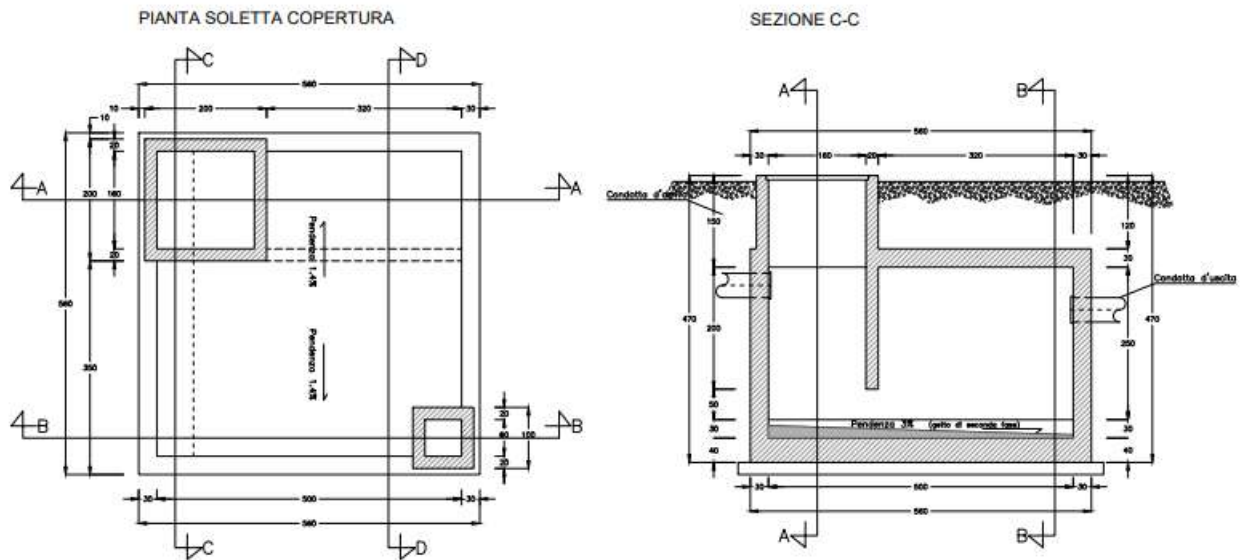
Sezione e planimetria della vasca di sicurezza idraulica
